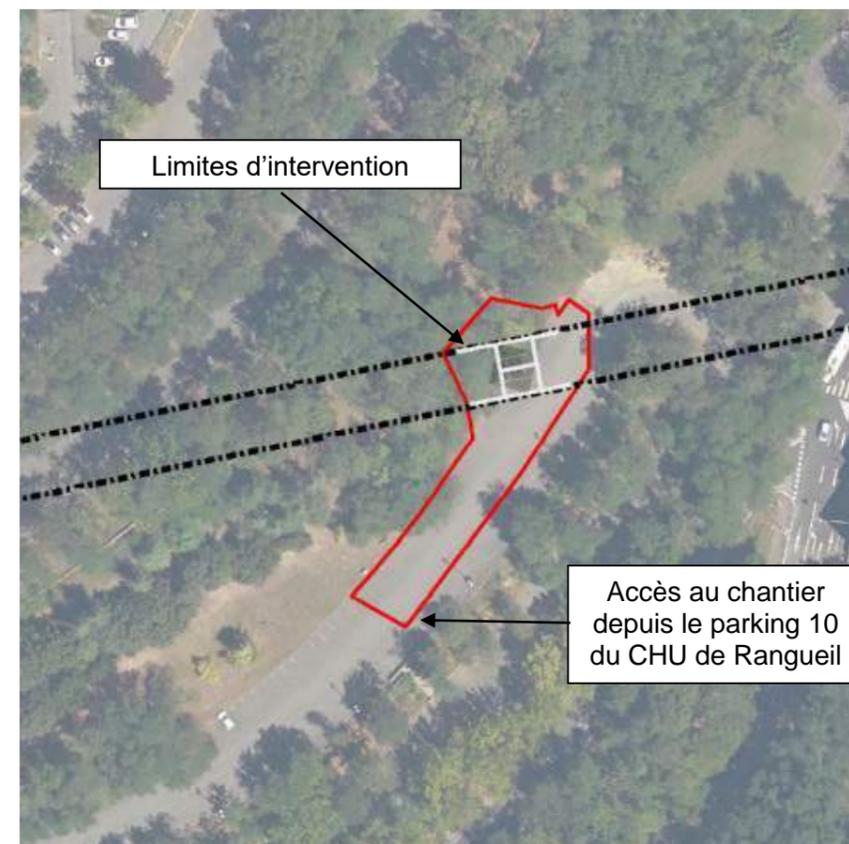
Plan de la zone travaux du pylône 4 (Source : Groupement POMA, 2018).
